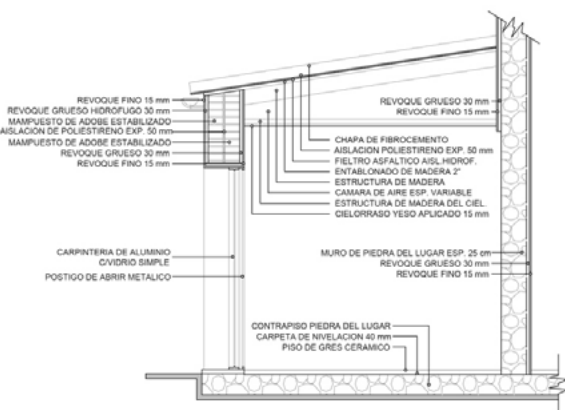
Detalle y sistema constructivo de la vivienda de Cachi.
